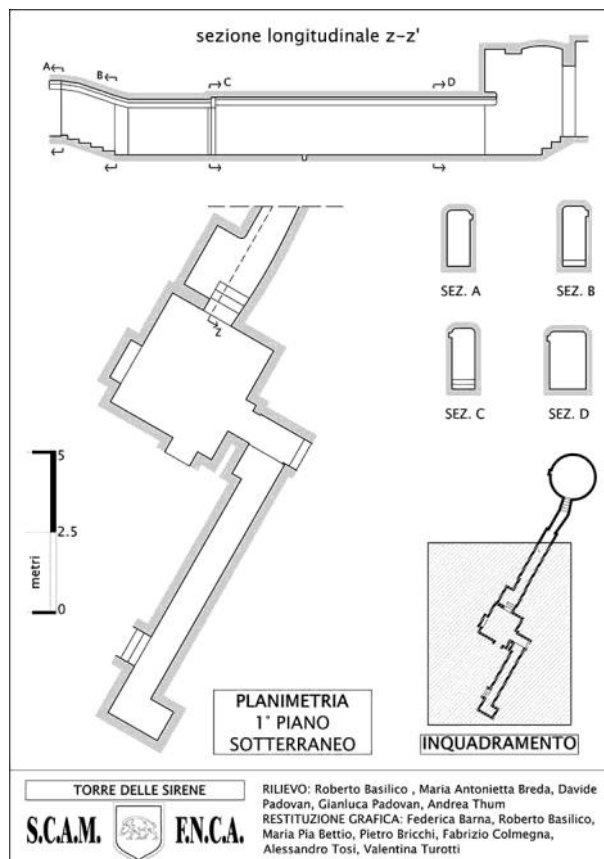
Sotterranei d'accesso alla Torre delle Sirene: dalla stanza a pianta quadrata gli scalini conducono al corridoio sotterraneo (rilievo dell'Ass.ne S.C.A.M. - F.N.C.A.).
